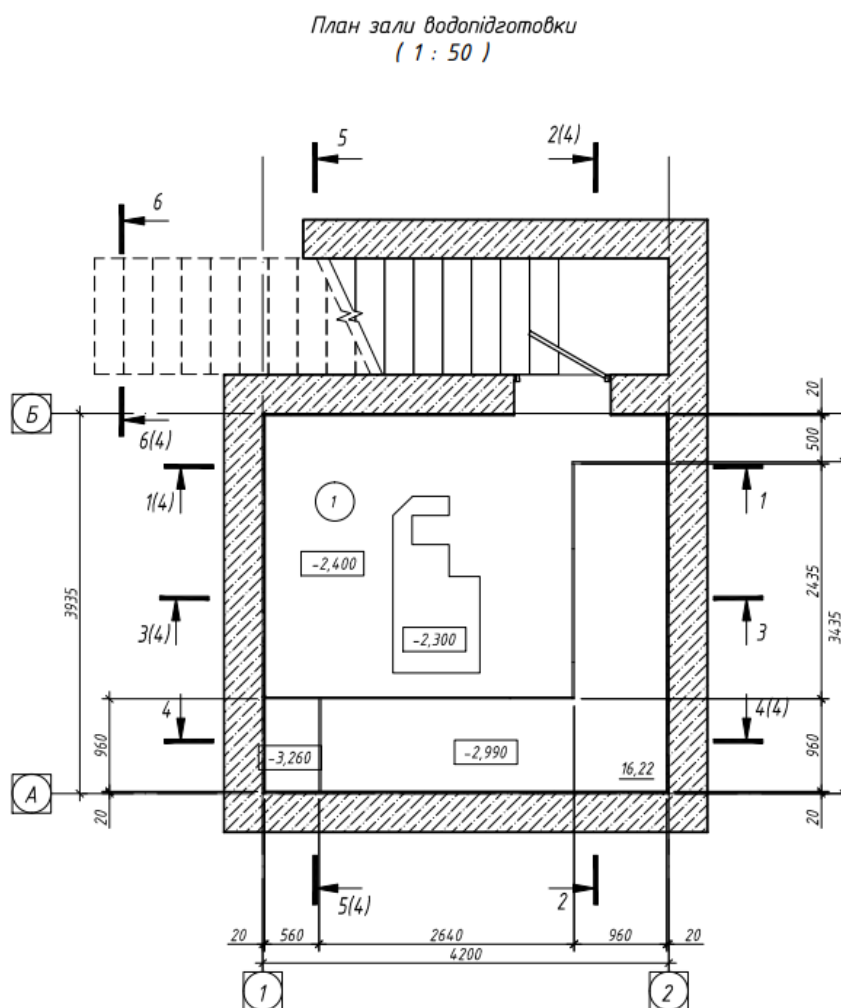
План приміщення насосної станції 3-го (Розріз 1-1)
